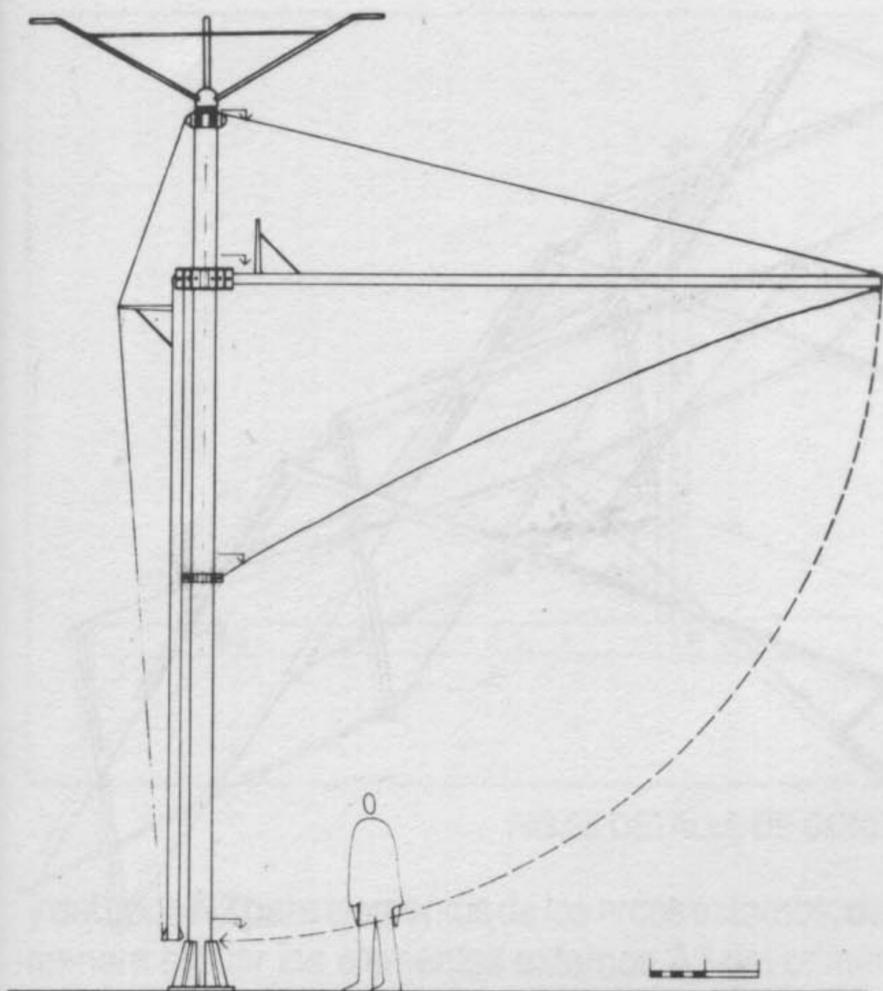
ELEVACION DE CUBIERTA TIPO PARAGUA
